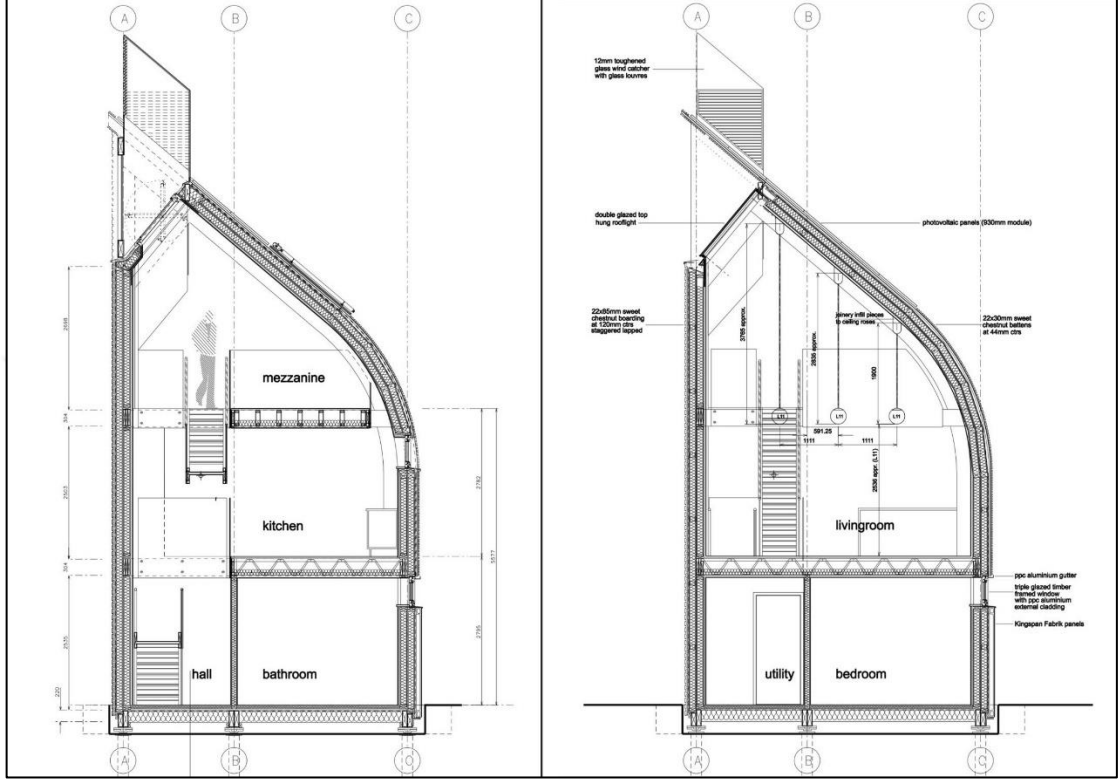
Çatı planındaki badgirin konumu [105]
